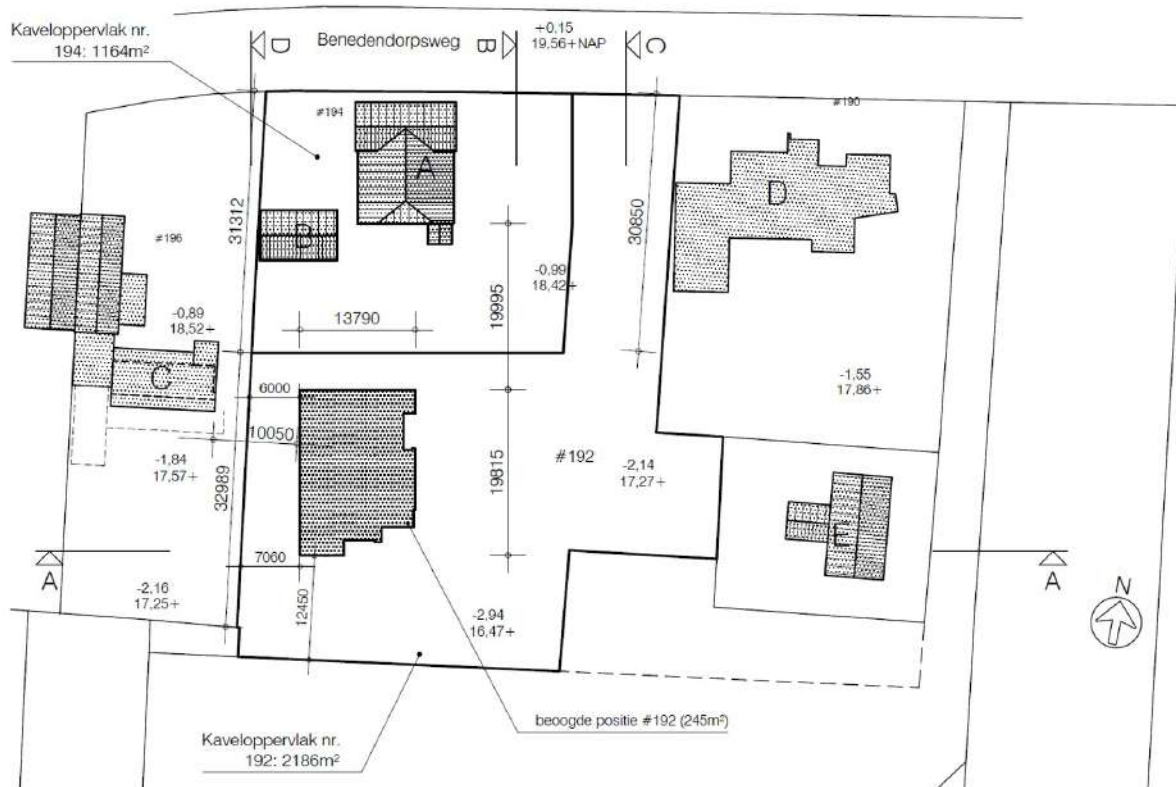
Plattegrond van de bestaande situatie van het plangebied (Bron: Frank van Haarlem)
